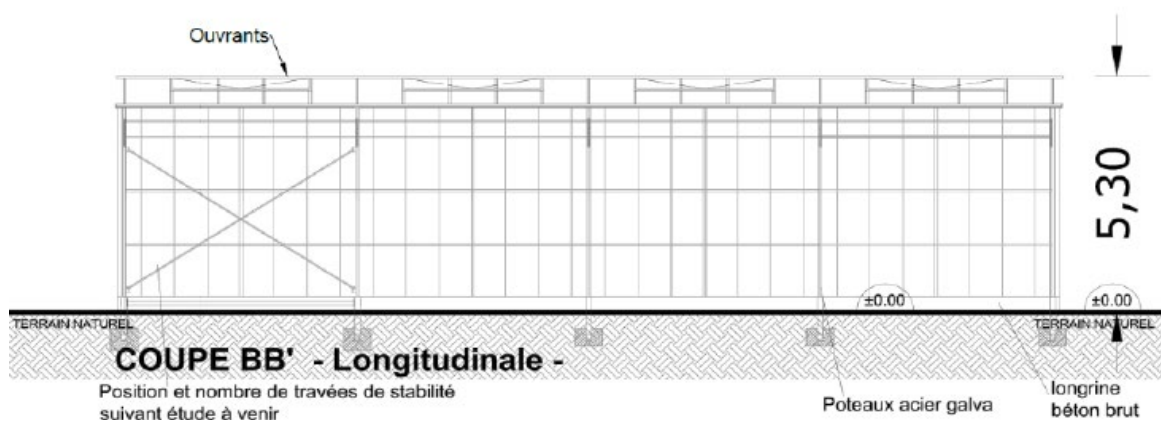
Coupe type serre multi-chapelles, côté long pan. Reden.
